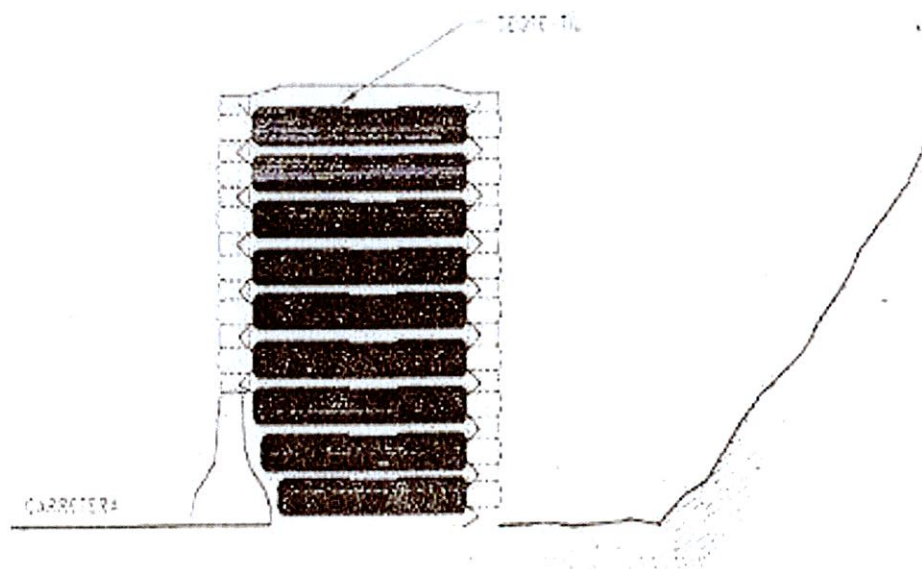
Barreras de tierra armada (con geotextil) para protección contra caídas y avalanchas.
